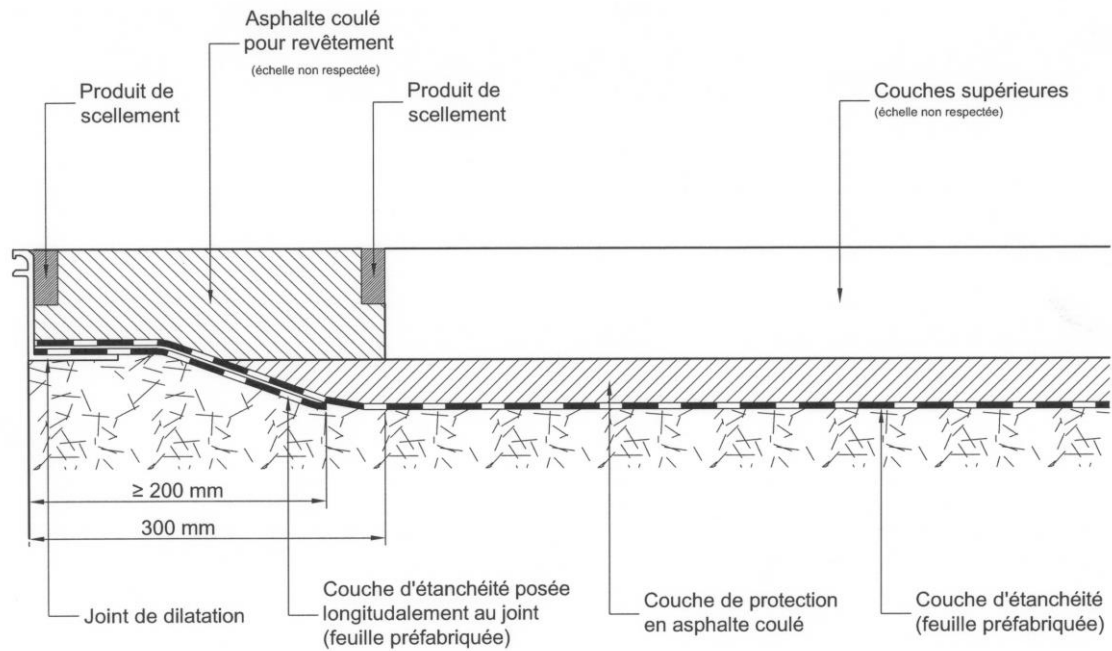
a.1.1. Raccordement à un joint de dilatation bétonné au niveau du tablier avant la pose du revêtement (couche de protection en asphalte coulé)
